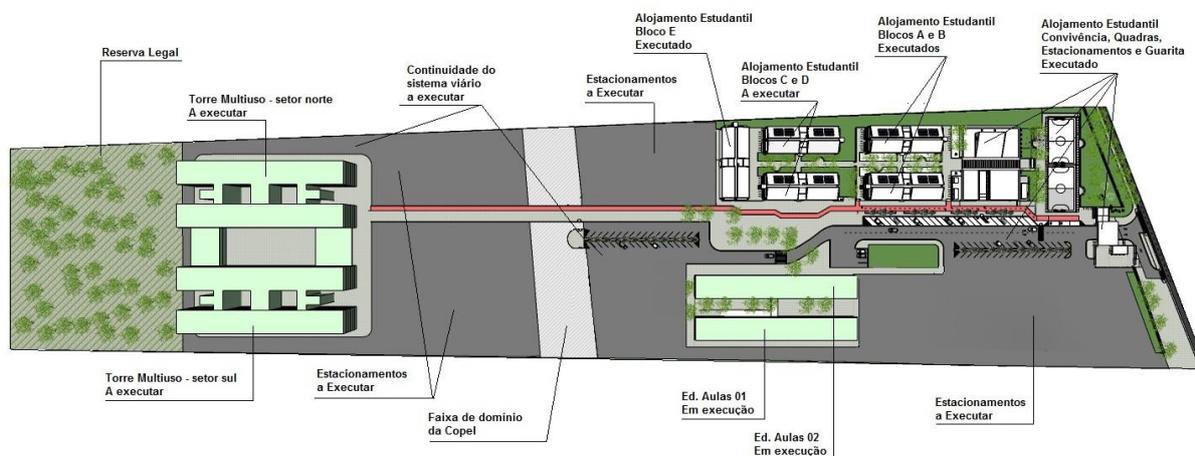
Plano de Edificações - Torres Multiuso 6 pavimentos e implantação viária/estacionamentos.
